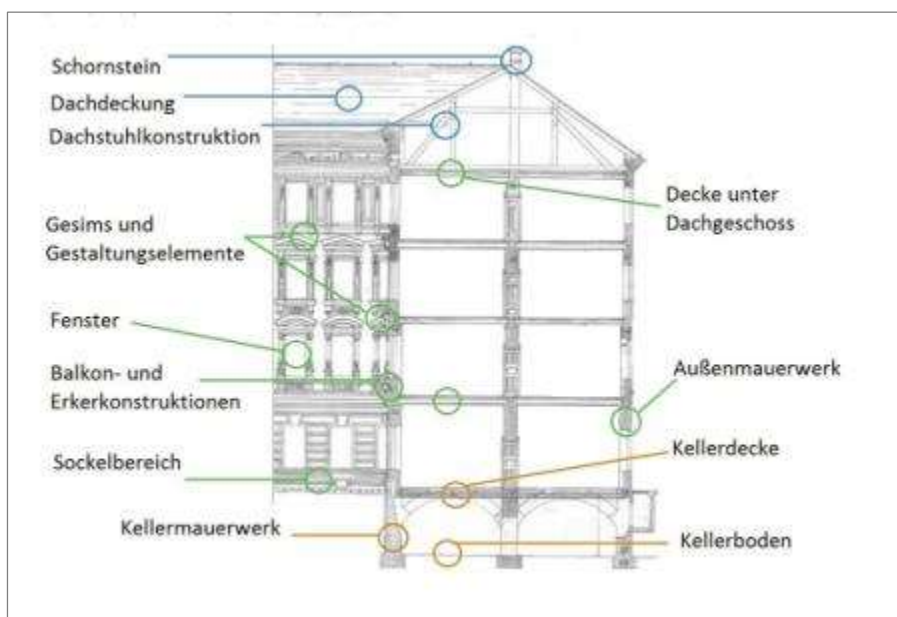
Gründerzeithaus und deren übliche Konstruktionen⁶
